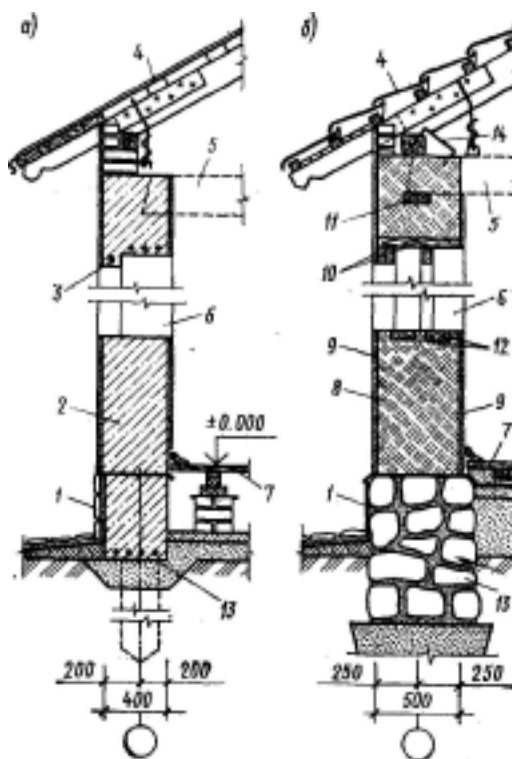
Разрезы наружных стен одноэтажных жилых домов из местных материалов:
